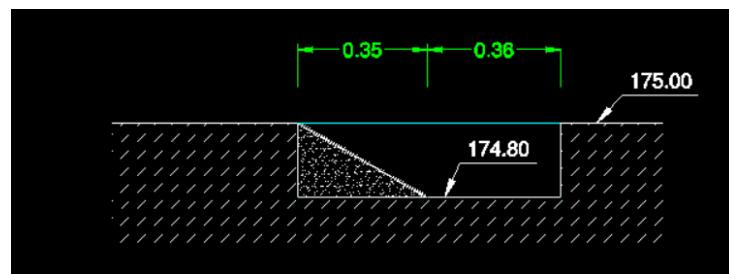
Coupe transversale de la rampe mixte (débit réservé et ouassous)
